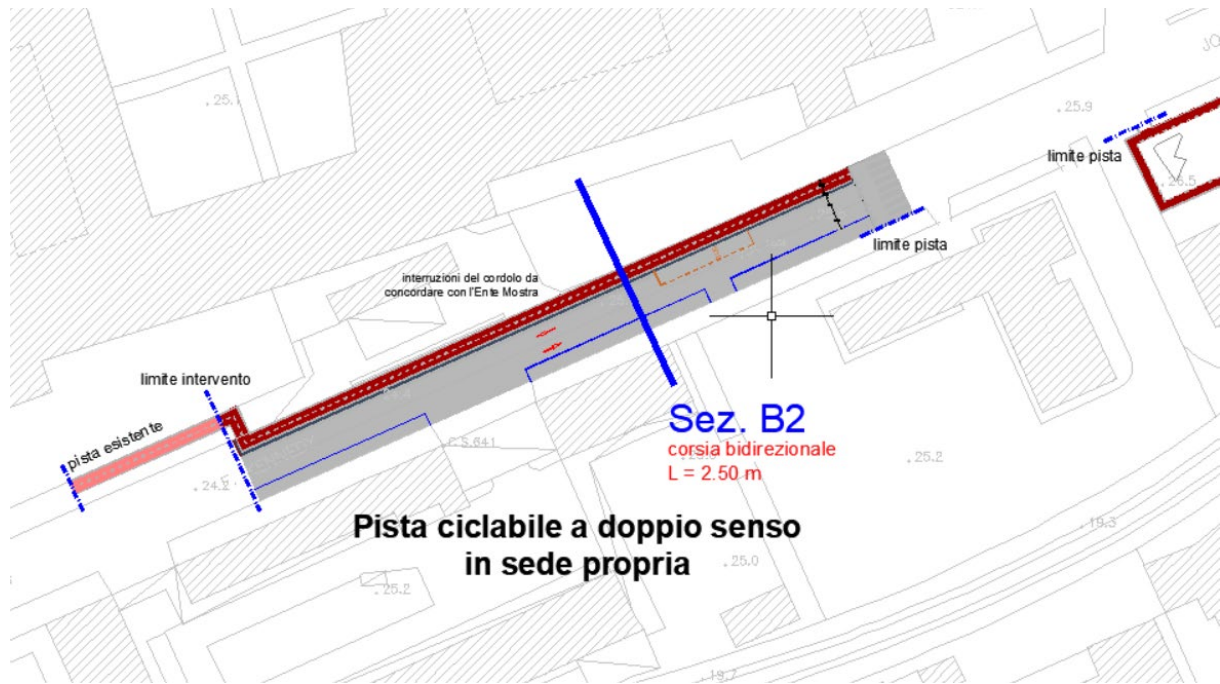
viale John Fitzgerald Kennedy – secondo tratto: andamento planimetrico della pista ciclabile.
